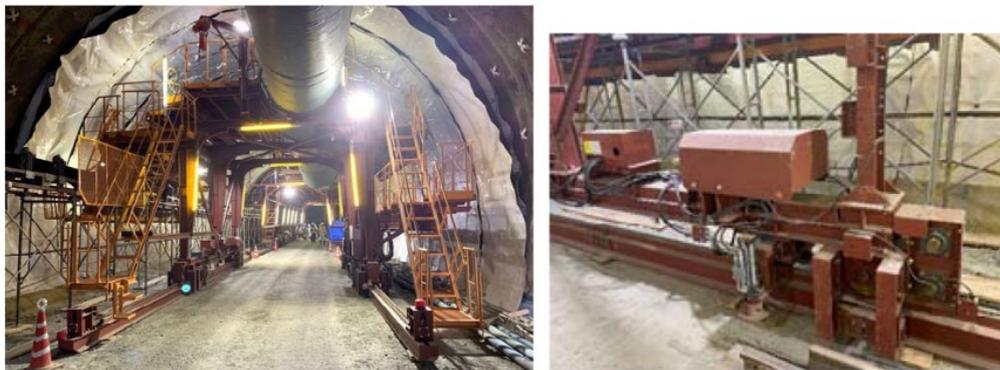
Rail Walker System の現場適用『福島県博士トンネル工事(昭和村側工区)』
